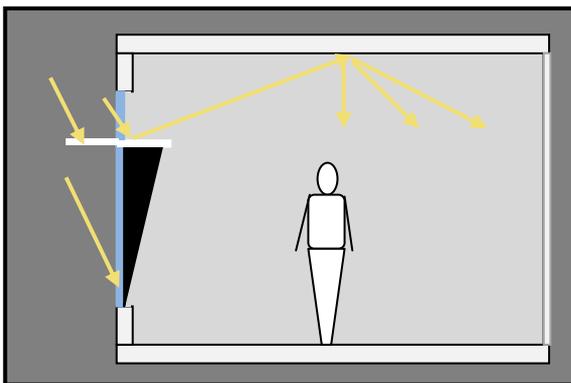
Façade avec dispositif d'ombrage intérieur et extérieur.
